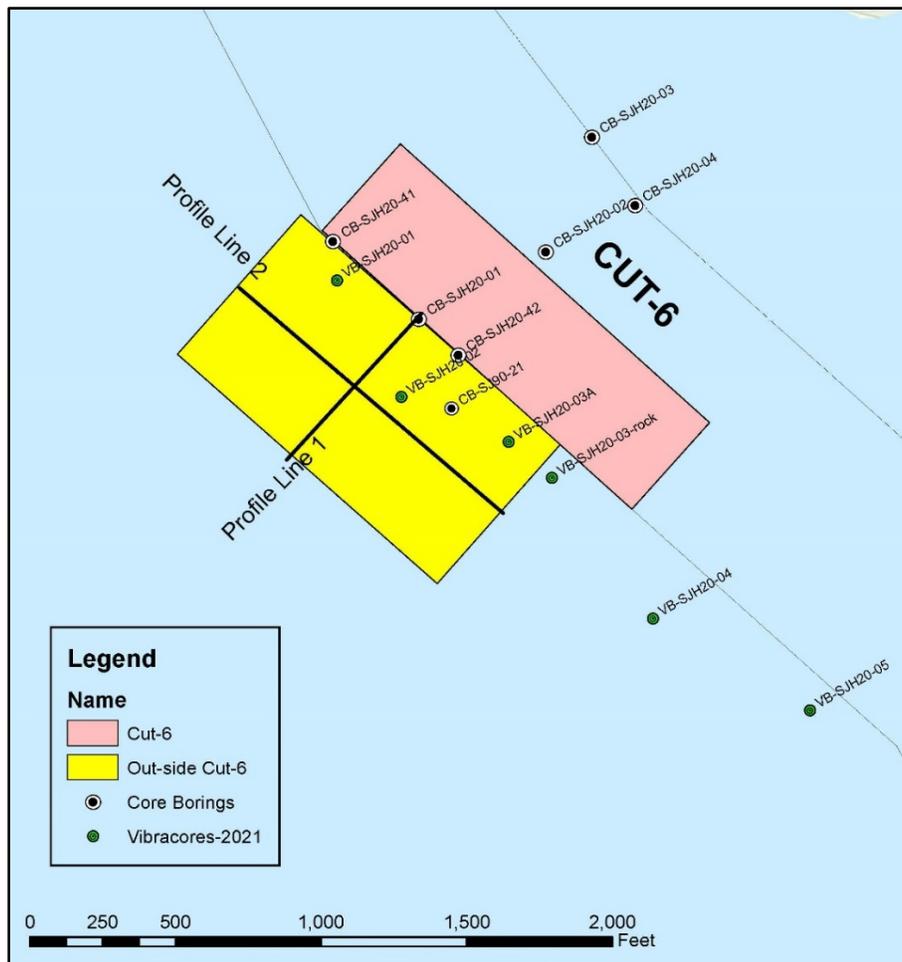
UBICACIONES DE MUESTRAS GEOTÉCNICAS EN EL ÁREA DE DRAGADO
